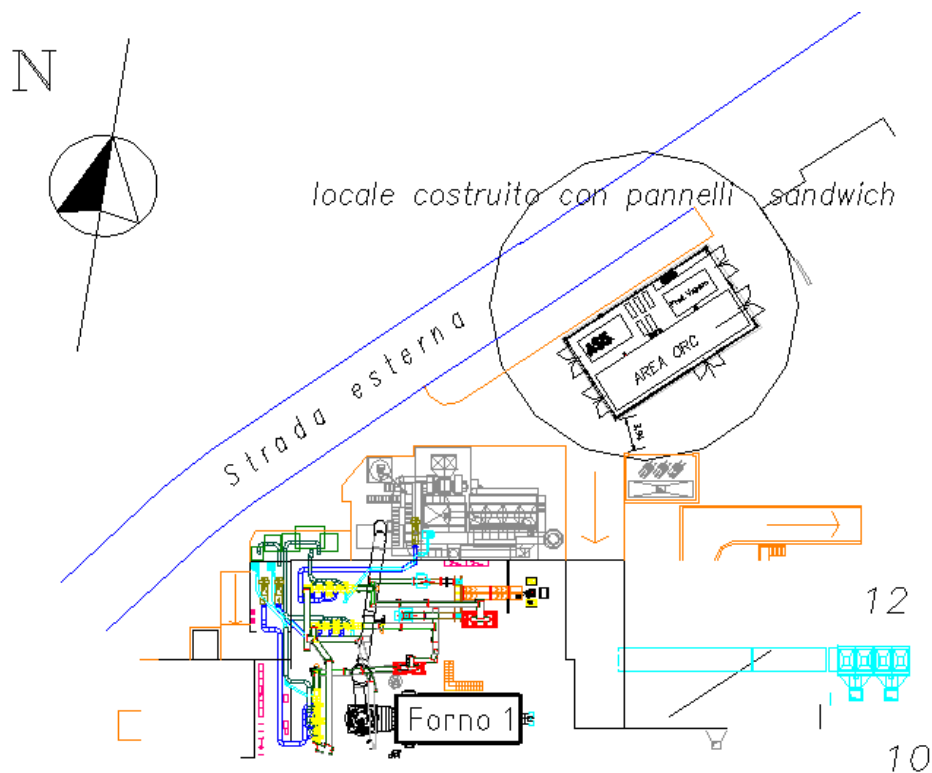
Posizionamento impianti rispetto al forno 1.
